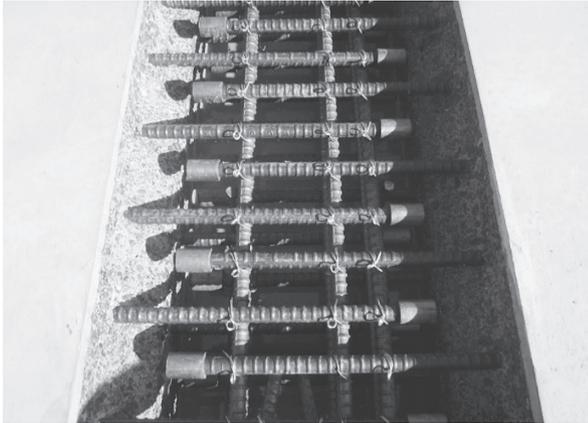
エンドバンド鉄筋 (SLJ スラブ工法)
